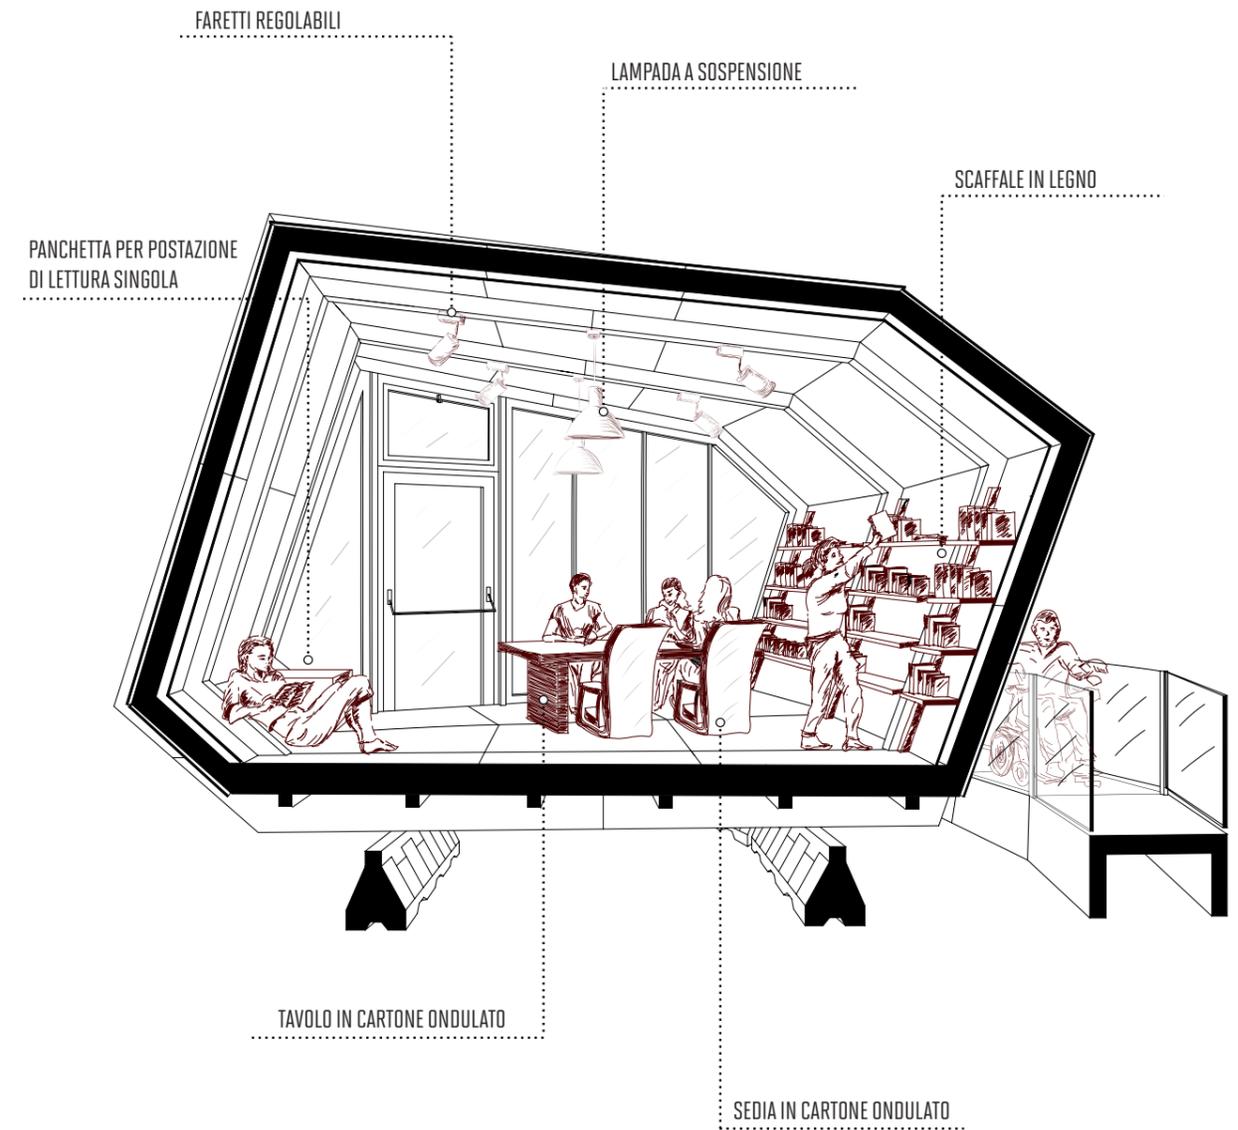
SEZIONE PROSPETTICA DEL BOX
